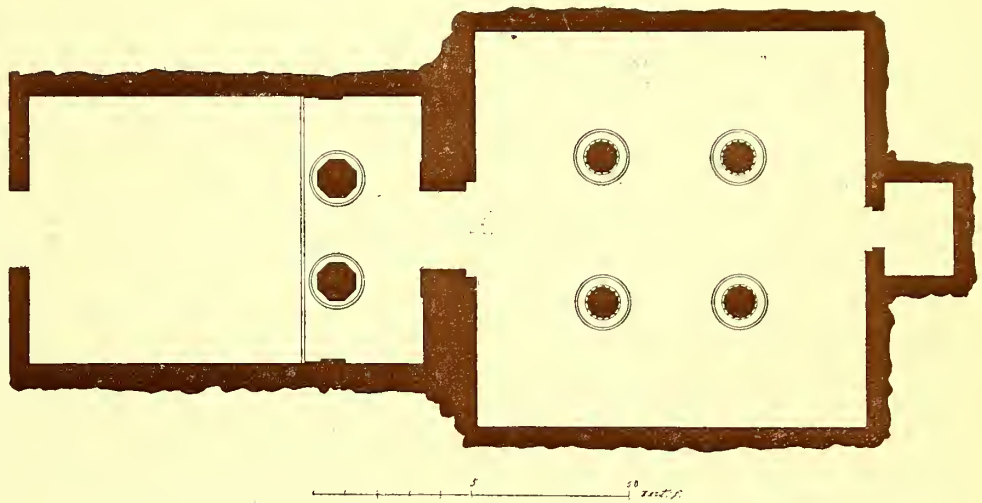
PLANTA DE LA TUMBA-HIPOGEO DE AMENI-AMENEMHAT, EN BENI-HASSÁN
